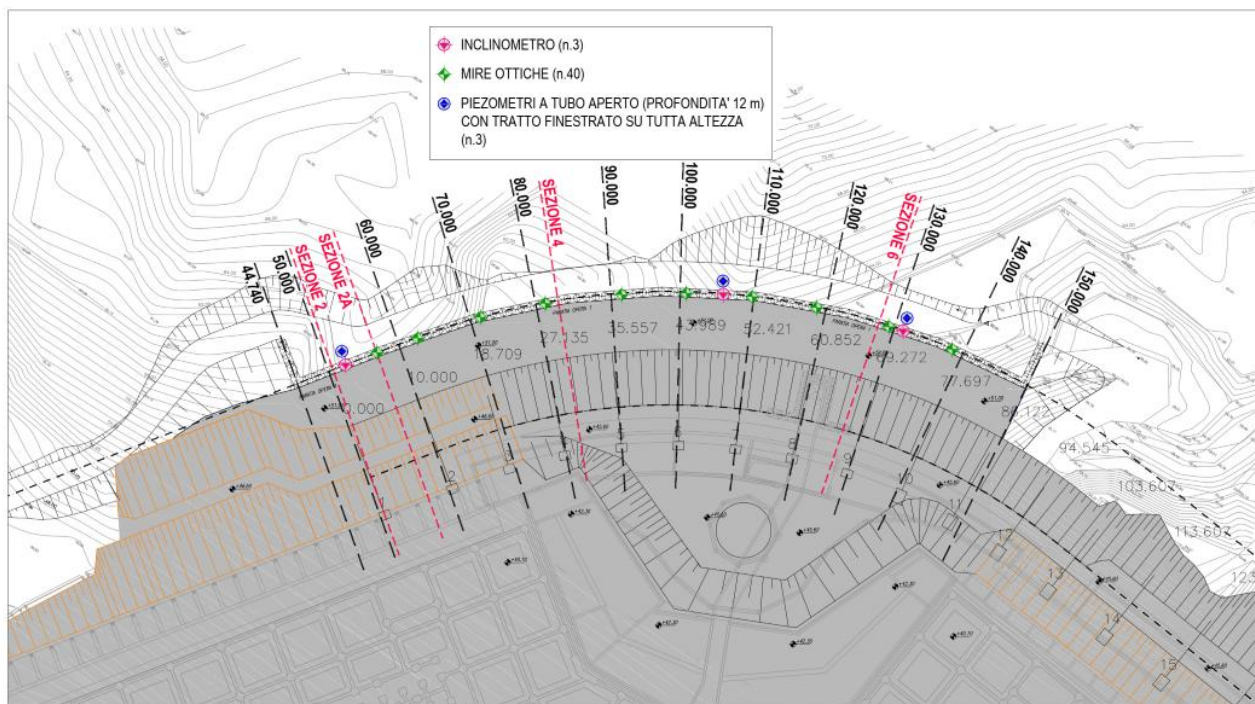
Planimetria strumentazione monitoraggio paratia
